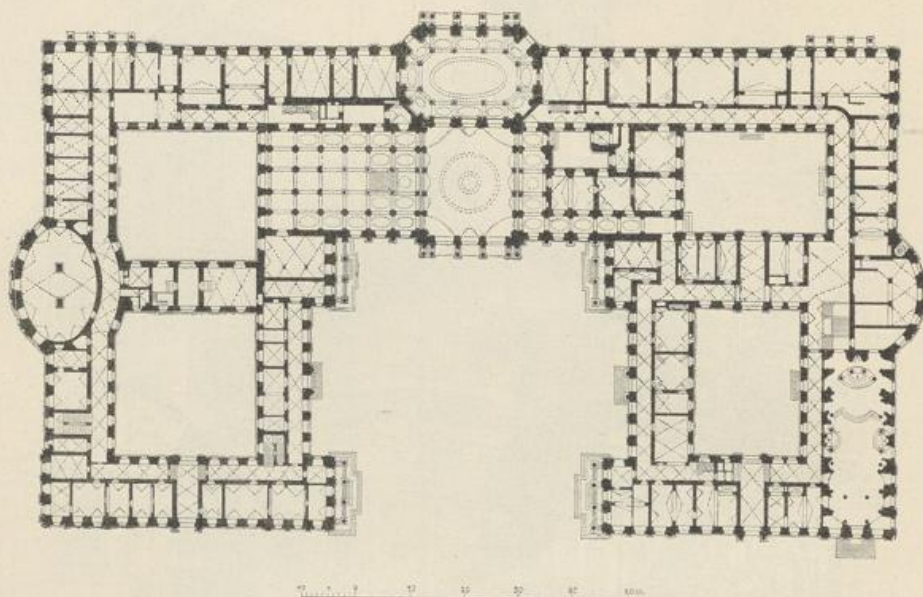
Grundriss des Erdgeschosses der Residenz zu Würzburg
